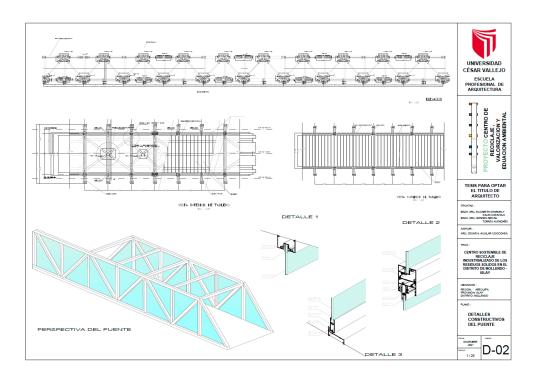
Plano de Detalles Constructivos de Puente FUENTE: Elaboración Propia
